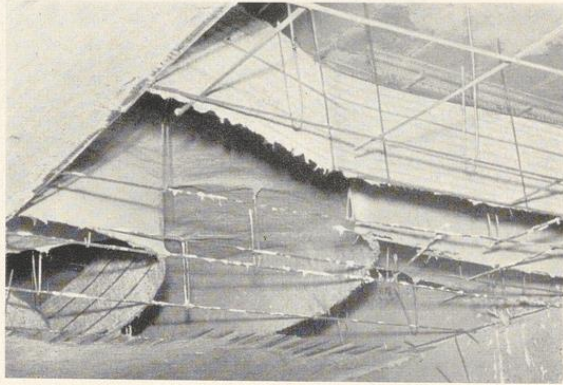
Entlüftungskanal und Decke in Rippenstreckmetall vorgespannt und mit Gipsmörtel ausgedrückt
